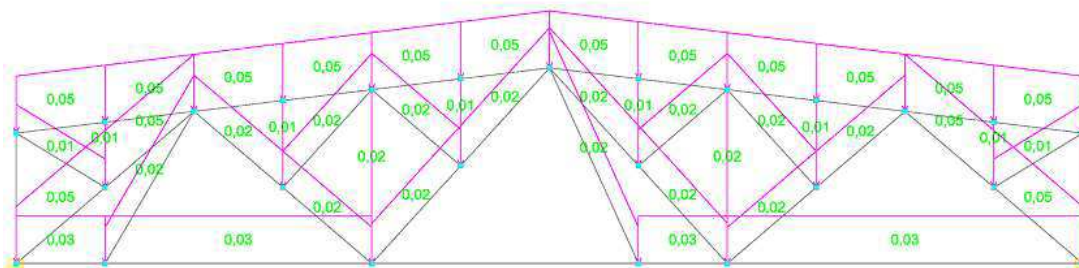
Схема загрузки фермы постоянной нагрузкой от собственного веса элементов
